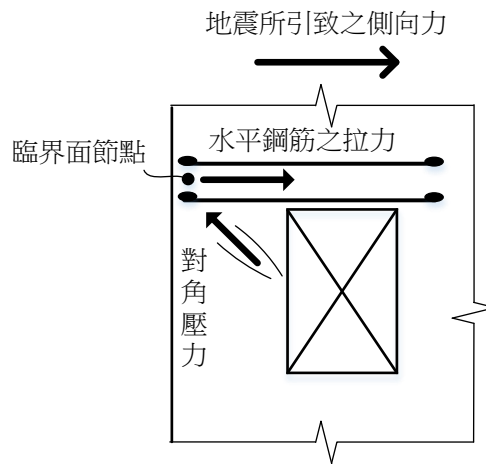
開口附近水平鋼筋作用示意圖[5]
